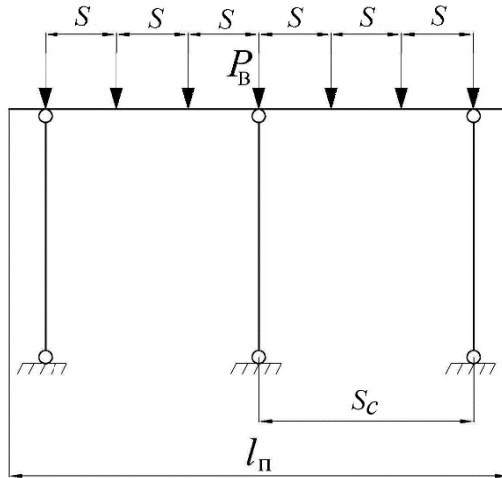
Расчетная схема прогона на стойках под верхняками.
